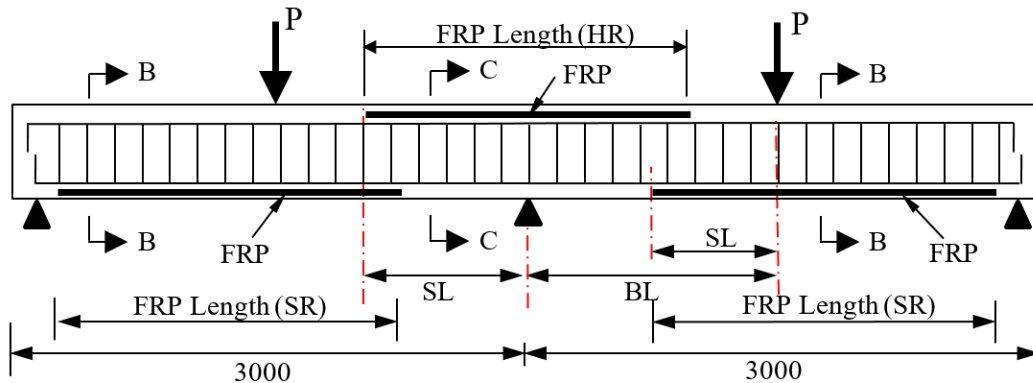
Schémas des poutres testées et leurs ferrailages. (toutes les dimensions sont en mm)
